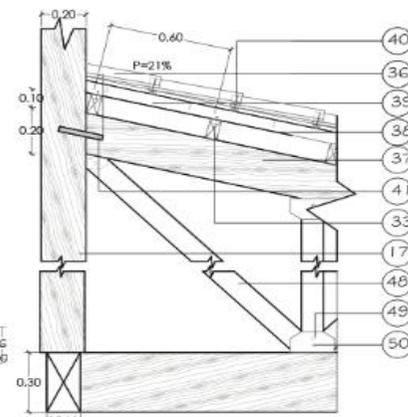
Detalle 10 (Cubierta)-Esc:1/20
